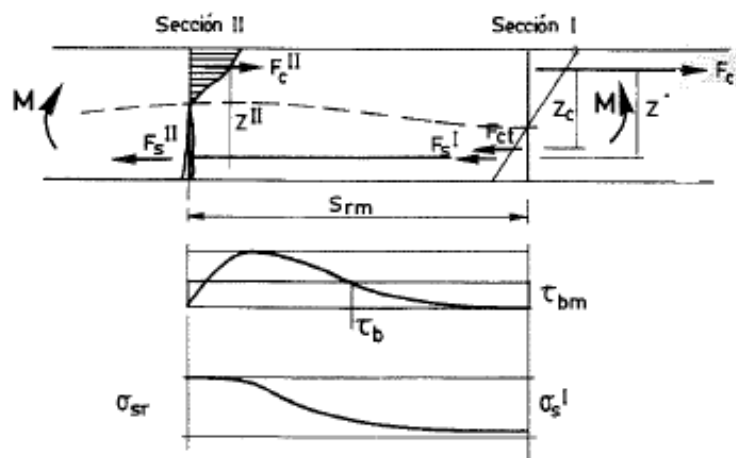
Tramo de viga de hormigón armado sometida a momento constante.
